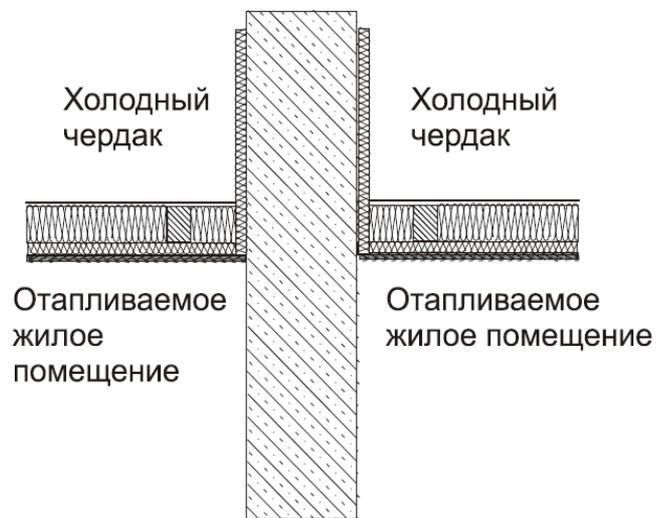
Схема утепления стыка внутренней стены с чердачным перекрытием [2]
